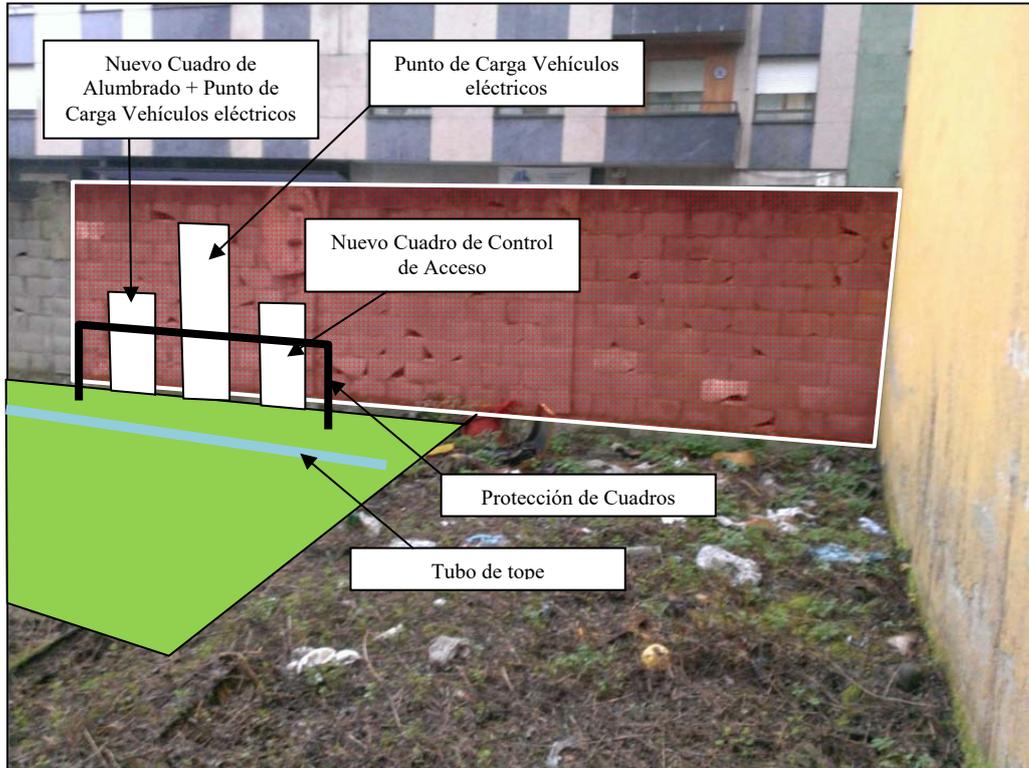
Vista exterior donde existe un portón que se retirará y se colocará ladrillo de bloque como el existente en el muro
